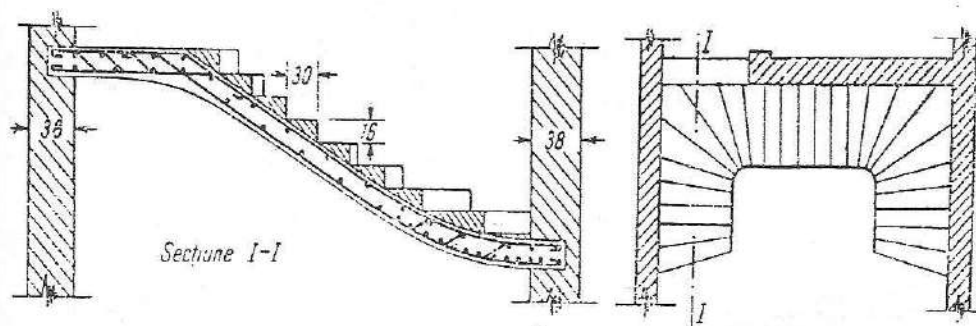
Scară de beton armat rezemată pe o placă turnată în pantă.
